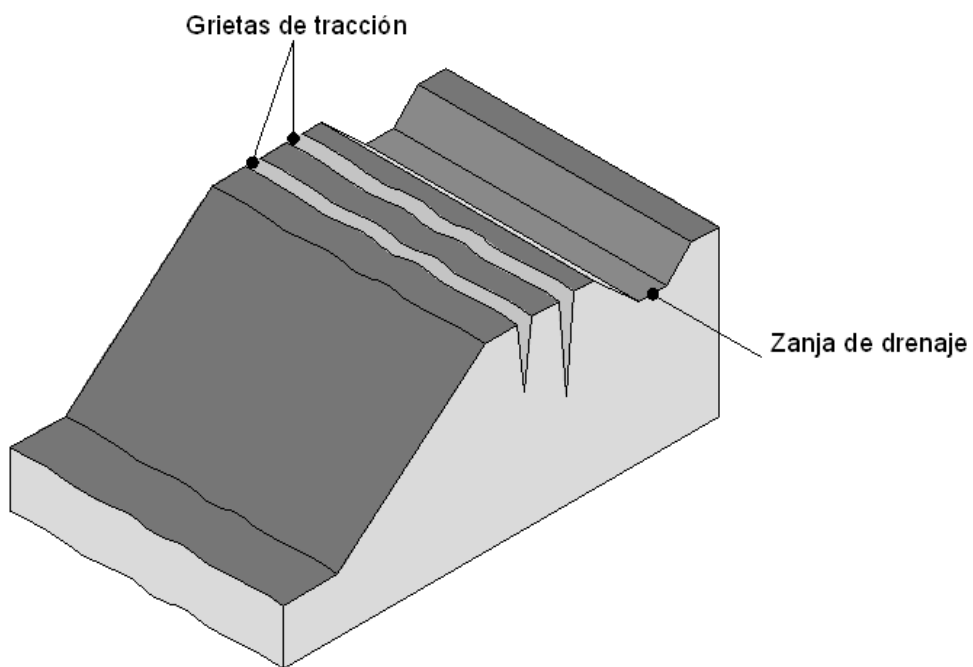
Zanja drenante en coronación (modificada de CANMET, 1977).
